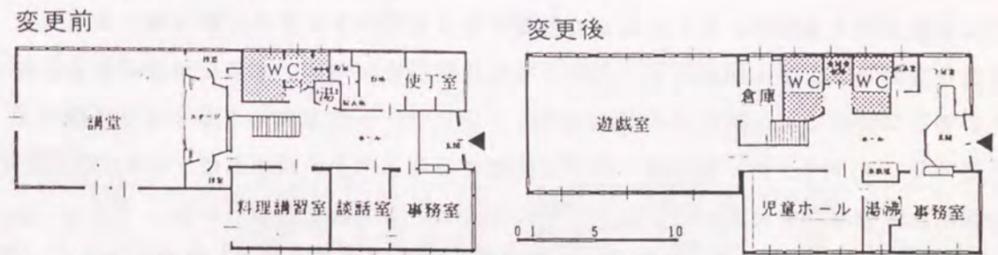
〈68〉所沢市まつば児童館(旧公民館)1階平面図
